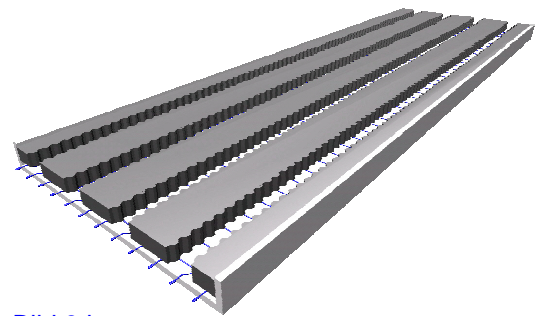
b: Stegchalung mit Kunststoffbauteilen
